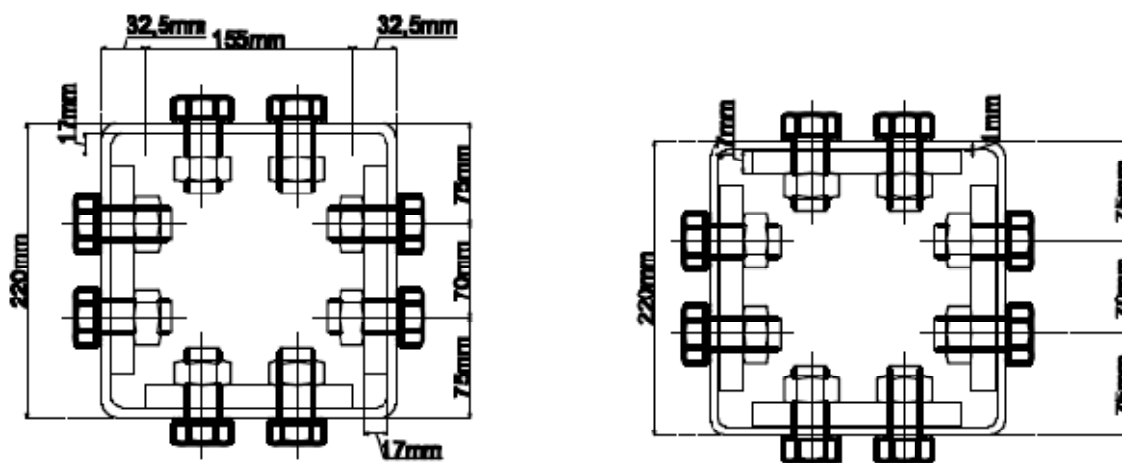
Corte da ligação pilar-pilar na zona aparafusada
